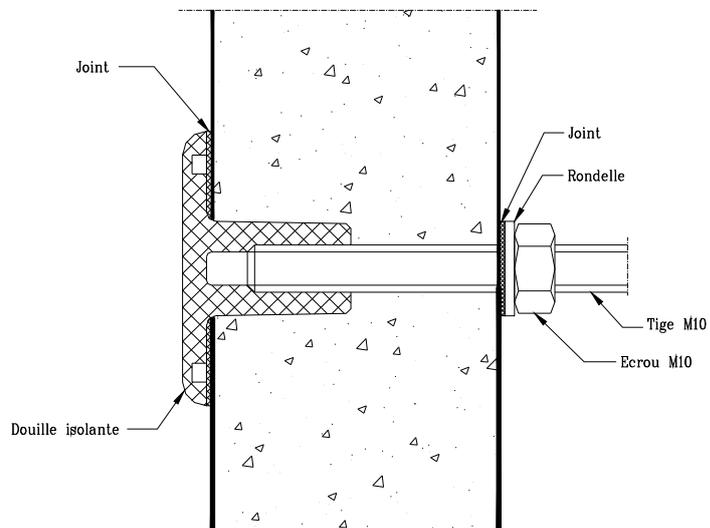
Fixation par vis traversantes ou douilles isolantes des panneaux LF en parois verticales
